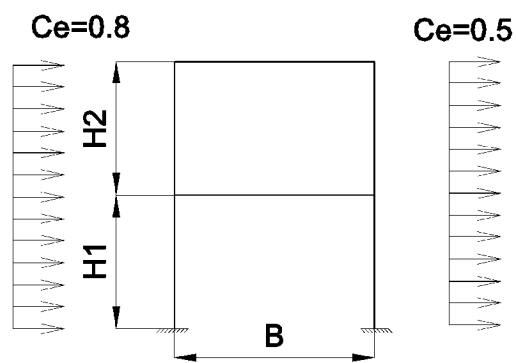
Схемы приложения ветровых нагрузок на каркас
